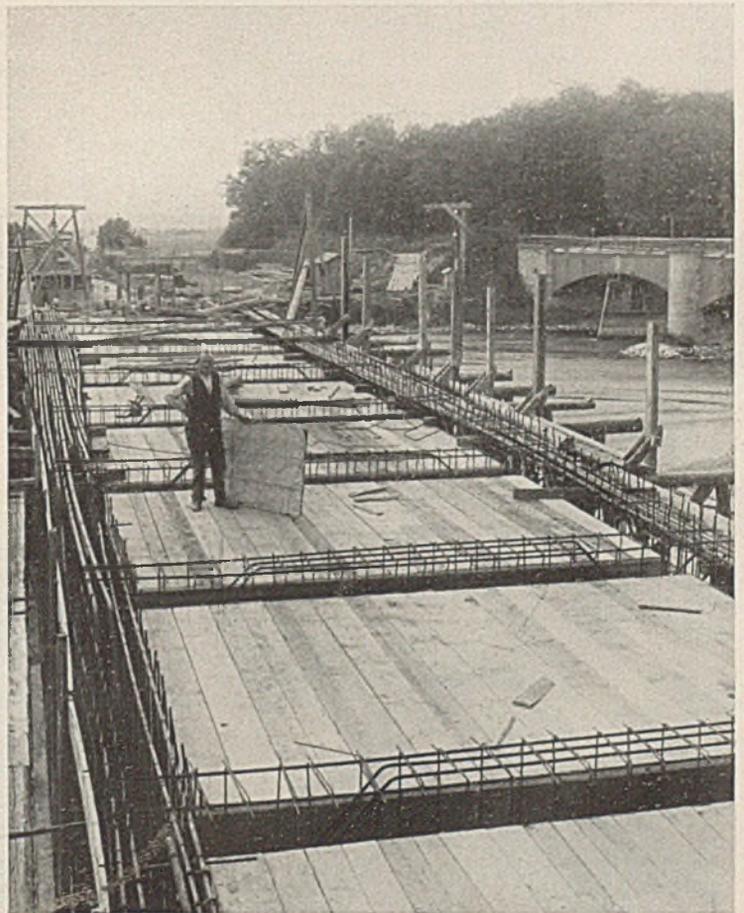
Aufsicht auf Trägerarmierung und Fahrbahn.
